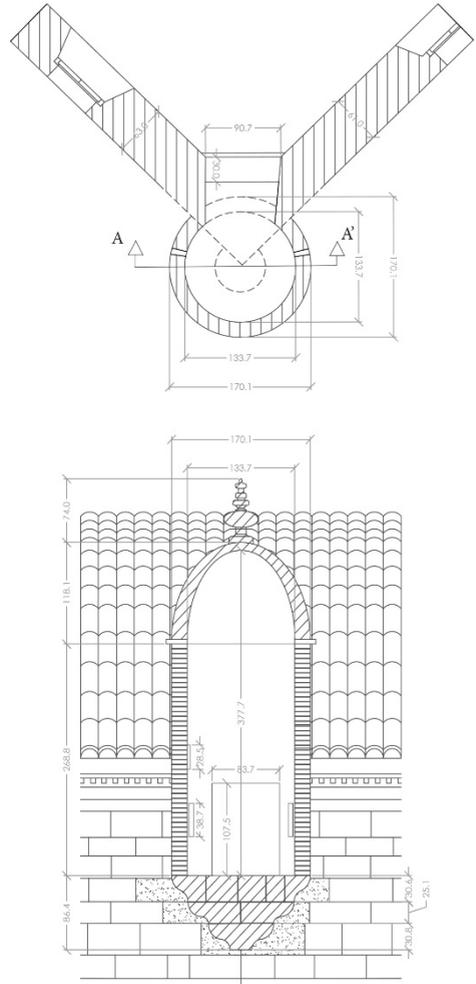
Planta y sección AA' de la garita 1 de Mas Cabanyes. Elaboración propia sobre planimetría de (Ranesi et al, 2020).
